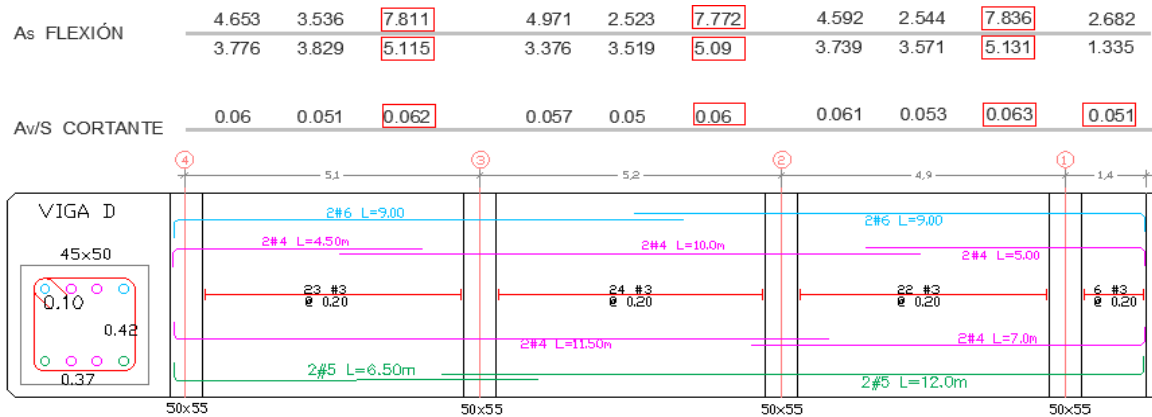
Cuantías obtenidas por esfuerzo a flexión, cortante y despiece de la viga D de la planta estructural. Fuente: elaboración propia.
